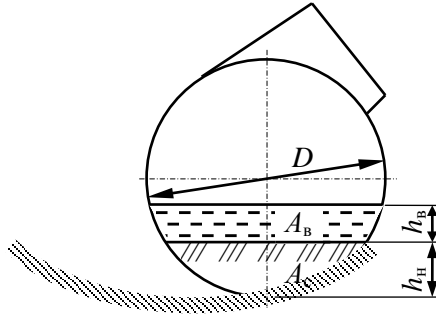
Схема к расчету площади поперечного сечения слоя воды над наносами
